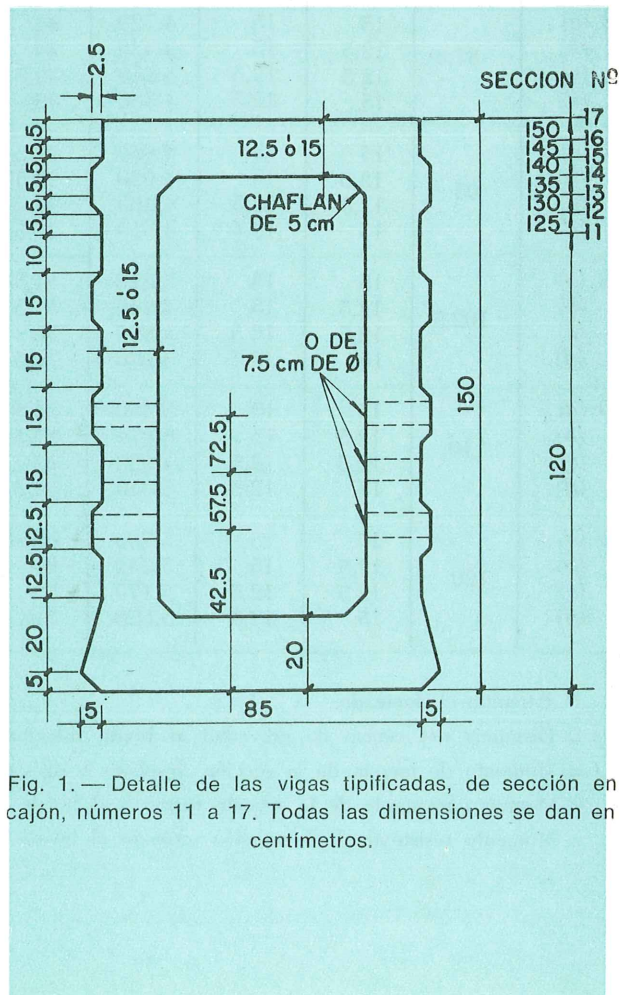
Detalle de las vigas tipificadas, de sección en cajón, números 11 a 17. Todas las dimensiones se dan en centímetros.
